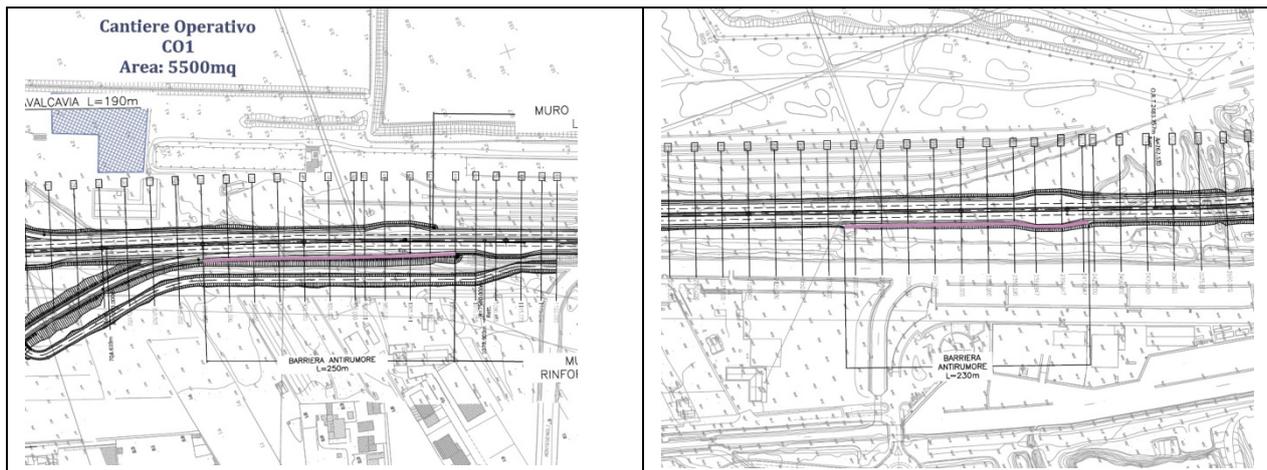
Stralci di Planimetria PD con inserimento di barriere antirumore
